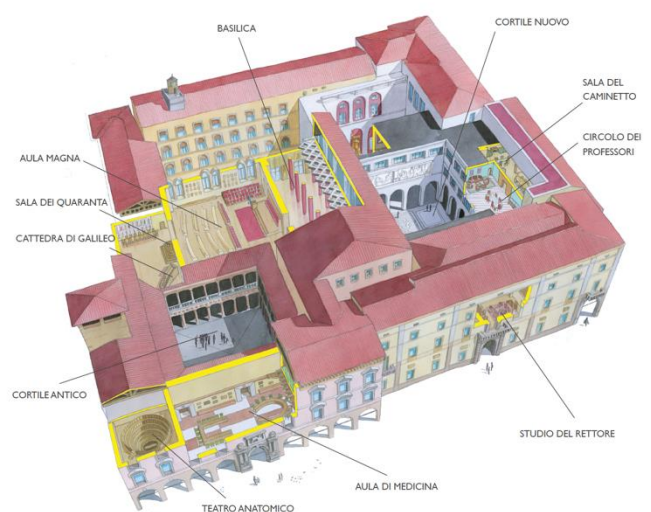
Об'ємна схема план будівлі Palazzo del Vo [11].
